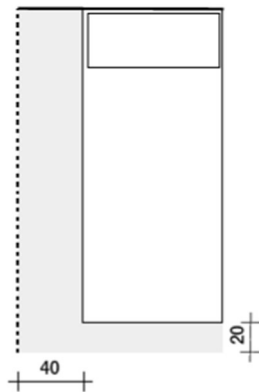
Espacio de cama en planta [Gráfico], Adaptado de: *Las medidas de la arquitectura* (p. 138) por: Steegman y Acebillo. 2008. Gustavo Gili
